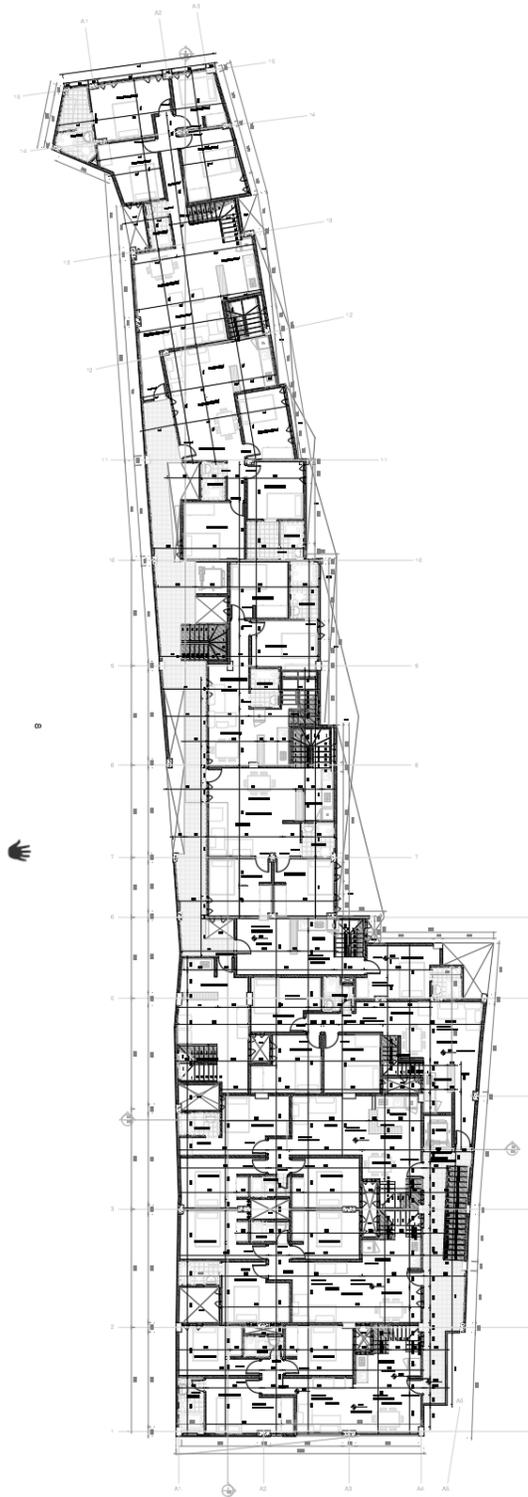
Planta arquitectónica nivel 1. Fuente:
